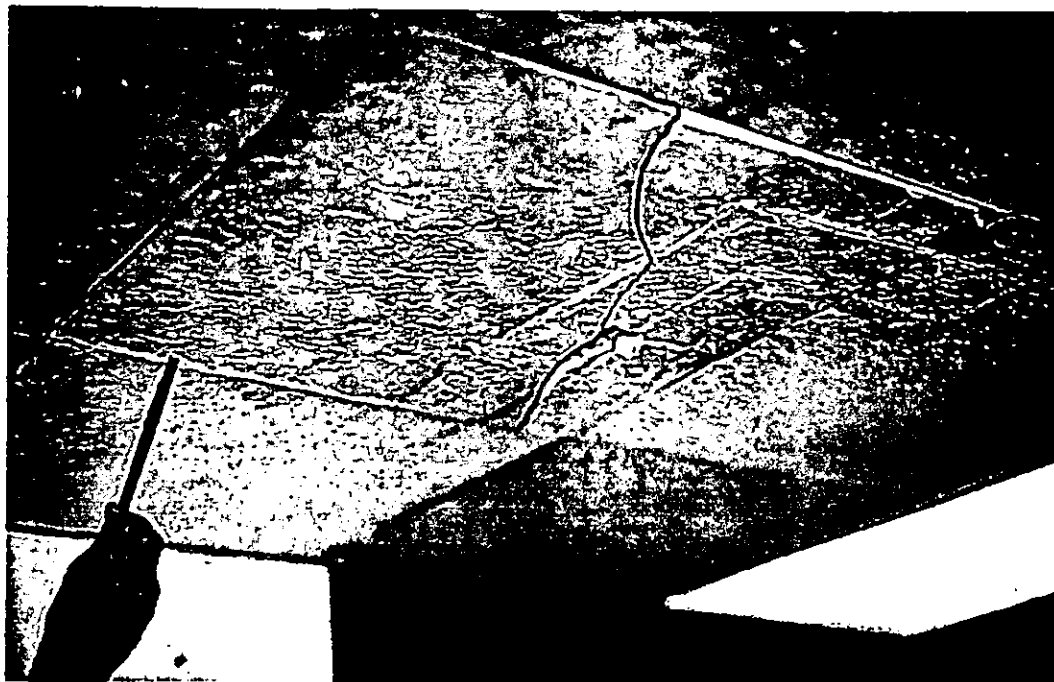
Daños en elementos no estructurales en plafones y en aplanados
